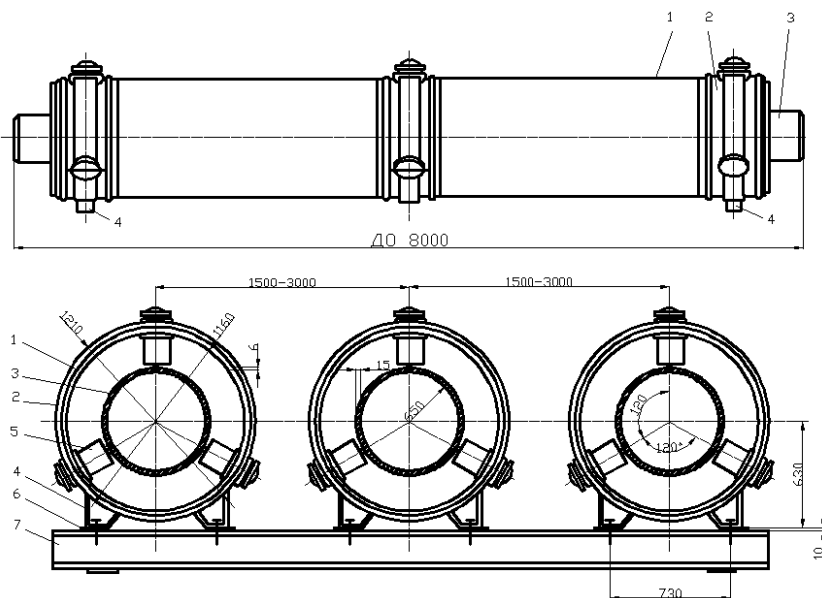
Крепление генераторных токопроводов к опорным конструкциям
